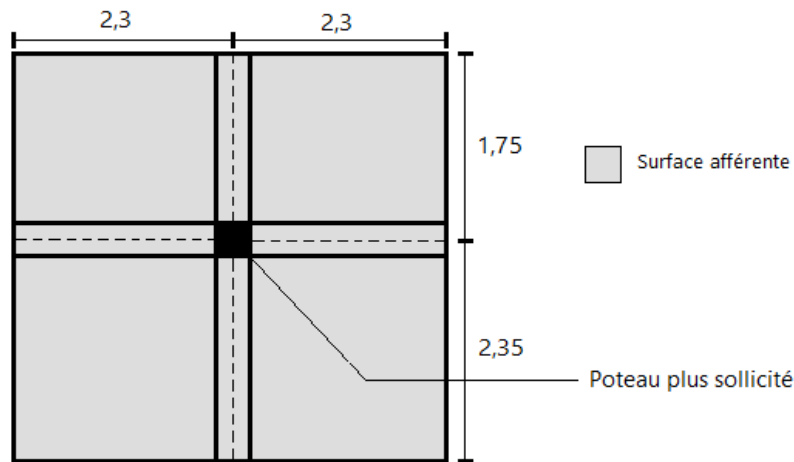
La section la plus sollicitée du poteau rectangulaire
